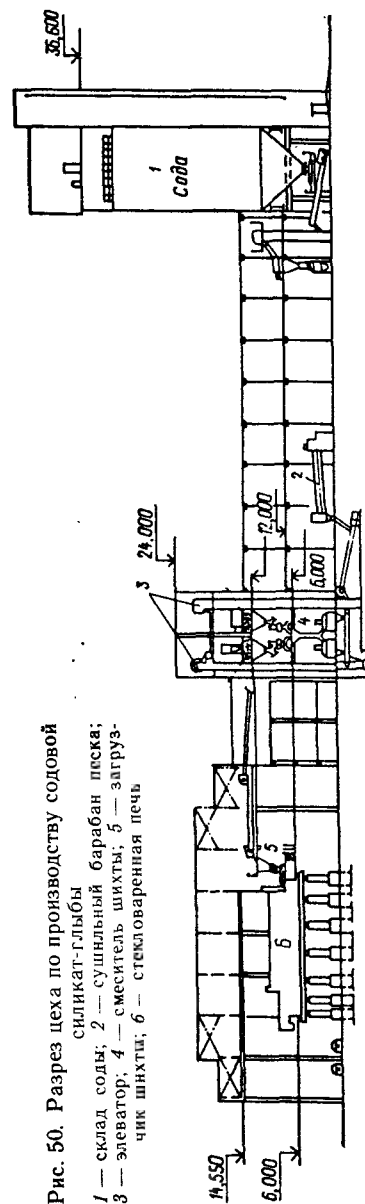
Разрез цеха по производству содовой силикат-глыбы: 1 — склад соды; 2 — сушильный барабан песка; 3 — элеватор; 4 — смеситель шихты; 5 — загрузчик шихты; 6 — стекловаренная печь
